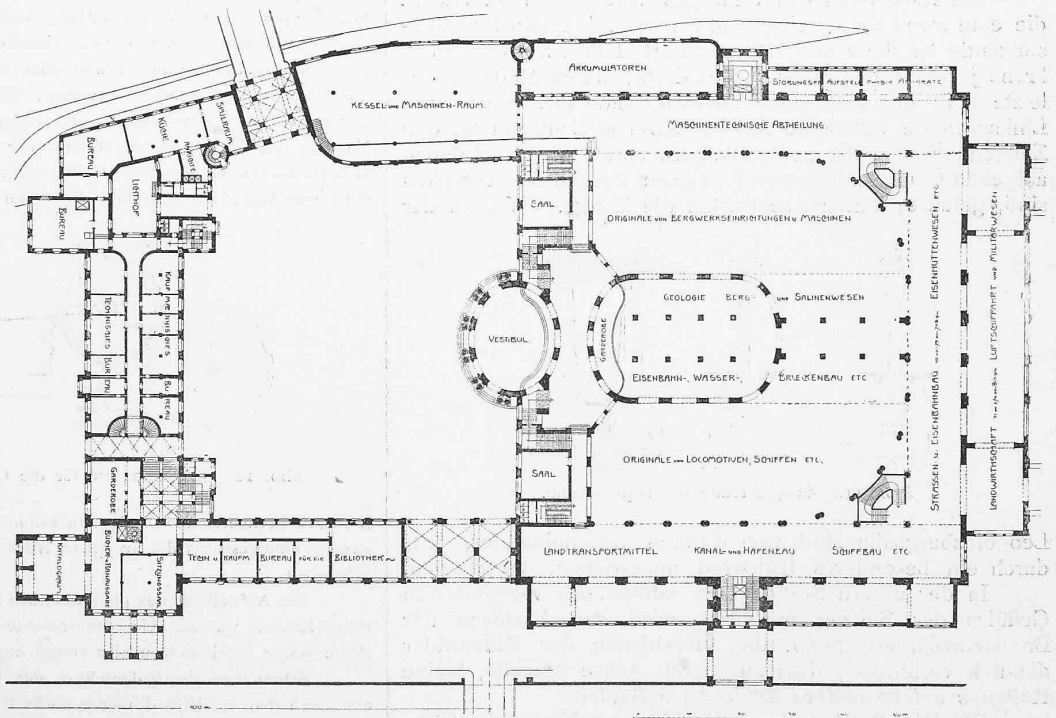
Grundriss vom Erdgeschoss des Entwurfs von Prof. Dr. Gabriel von Seidl. — Masstab 1 : 1330.
